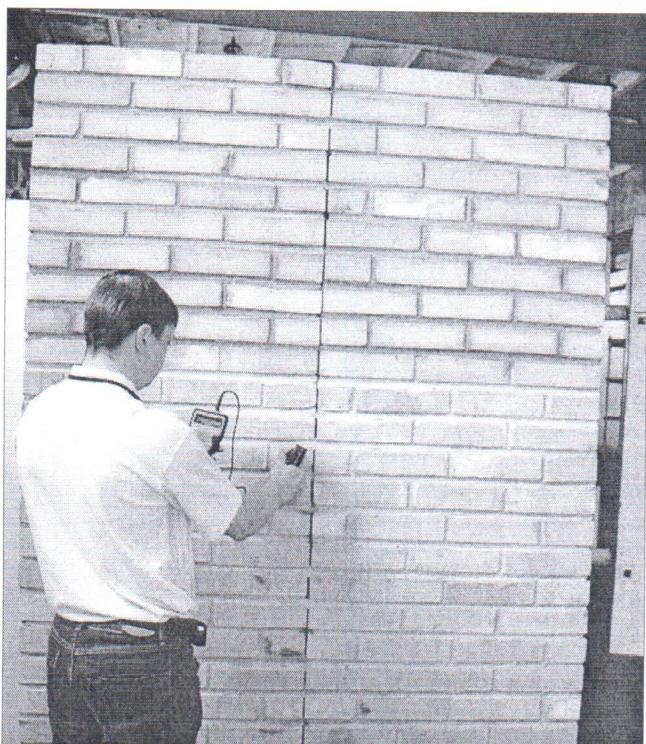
Крупноразмерный фрагмент стеновой конструкции для лабораторных испытаний
